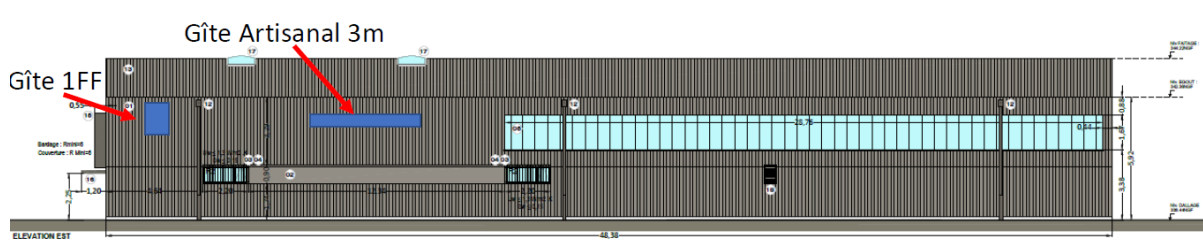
Localisation du gîte 1FF sur la façade est du nouveau bâtiment (Source : CPEPESC-Lorraine)
